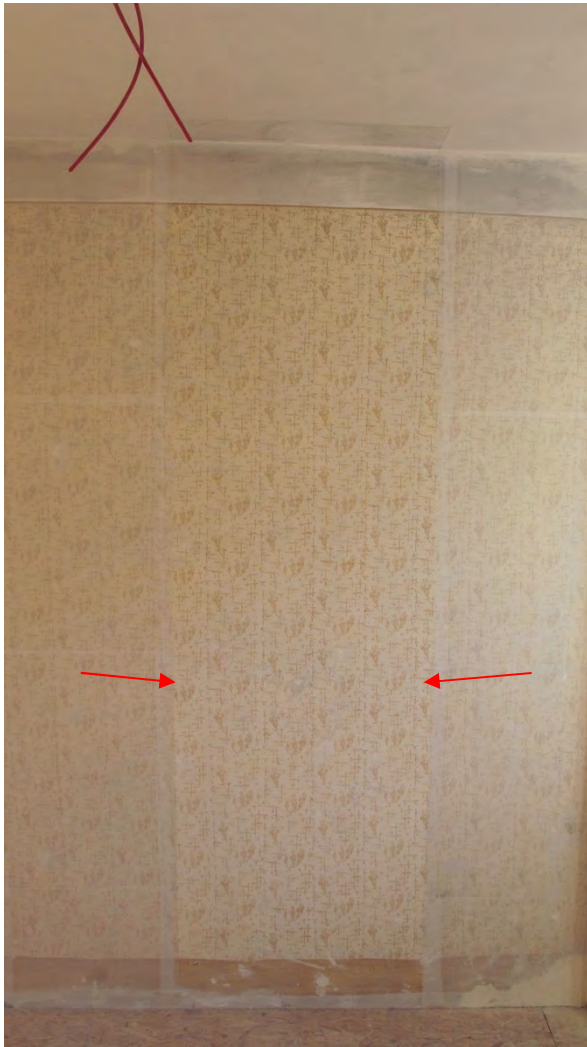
Raum 2.02, Wand c; Japanpapierschutz mit "Fenster in die Vergangenheit" (Pfeile).
